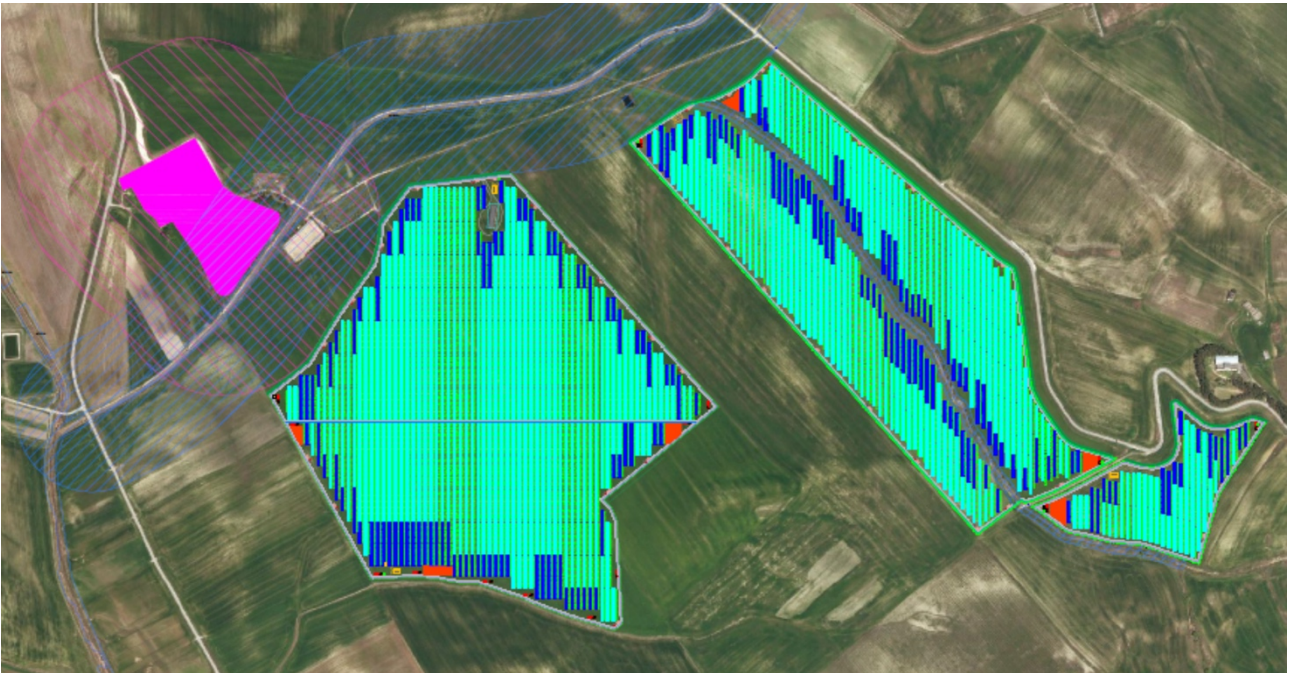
Planimetria generale dell'impianto fotovoltaico
